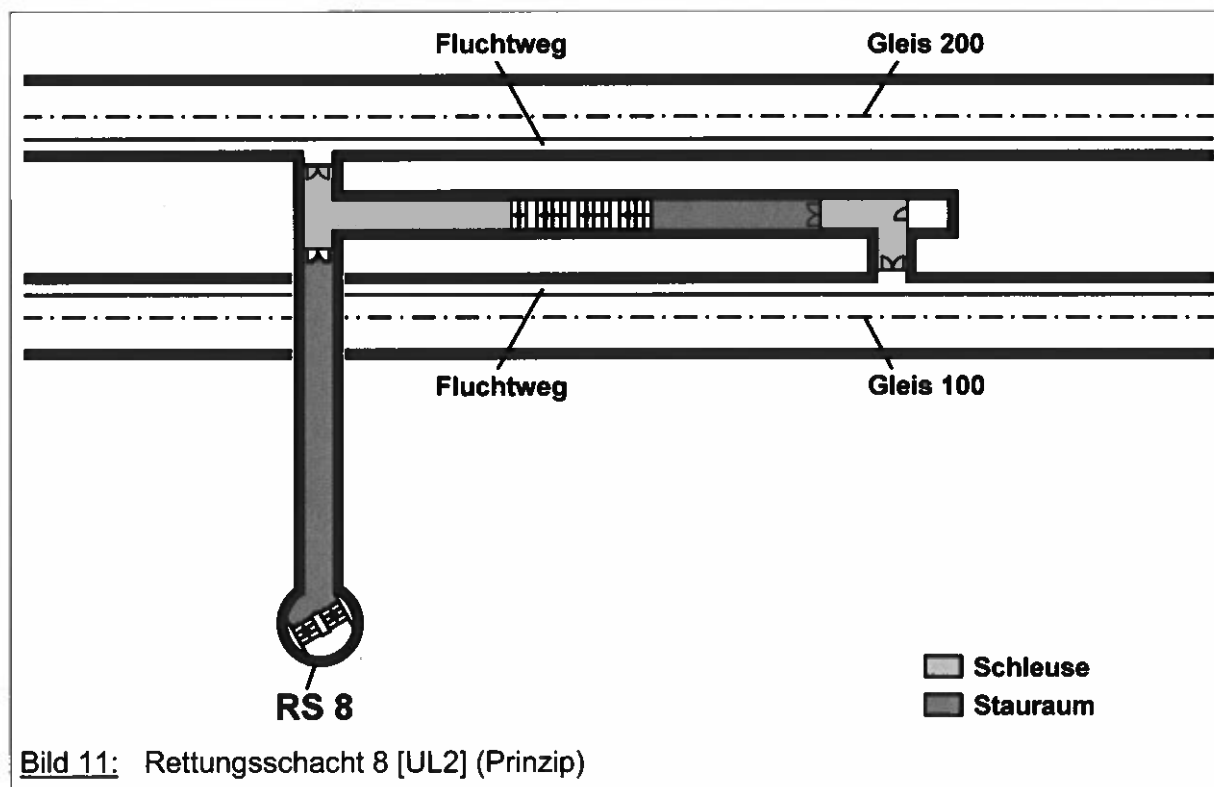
Rettungsschacht 8 [UL2] (Prinzip)
